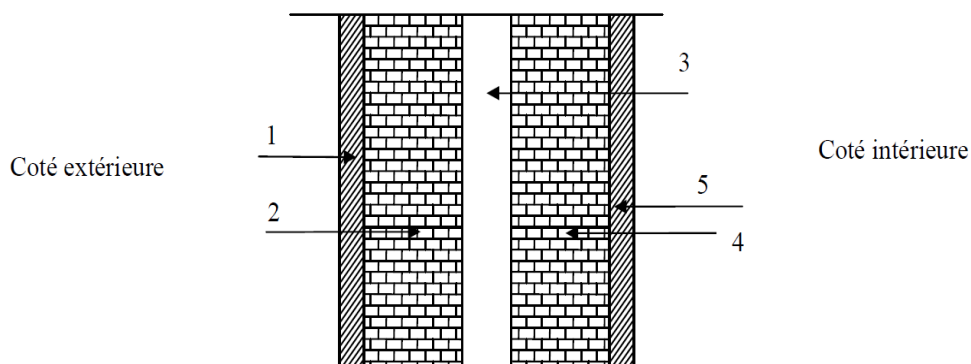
Coupe transversales d'un murs extérieurs
